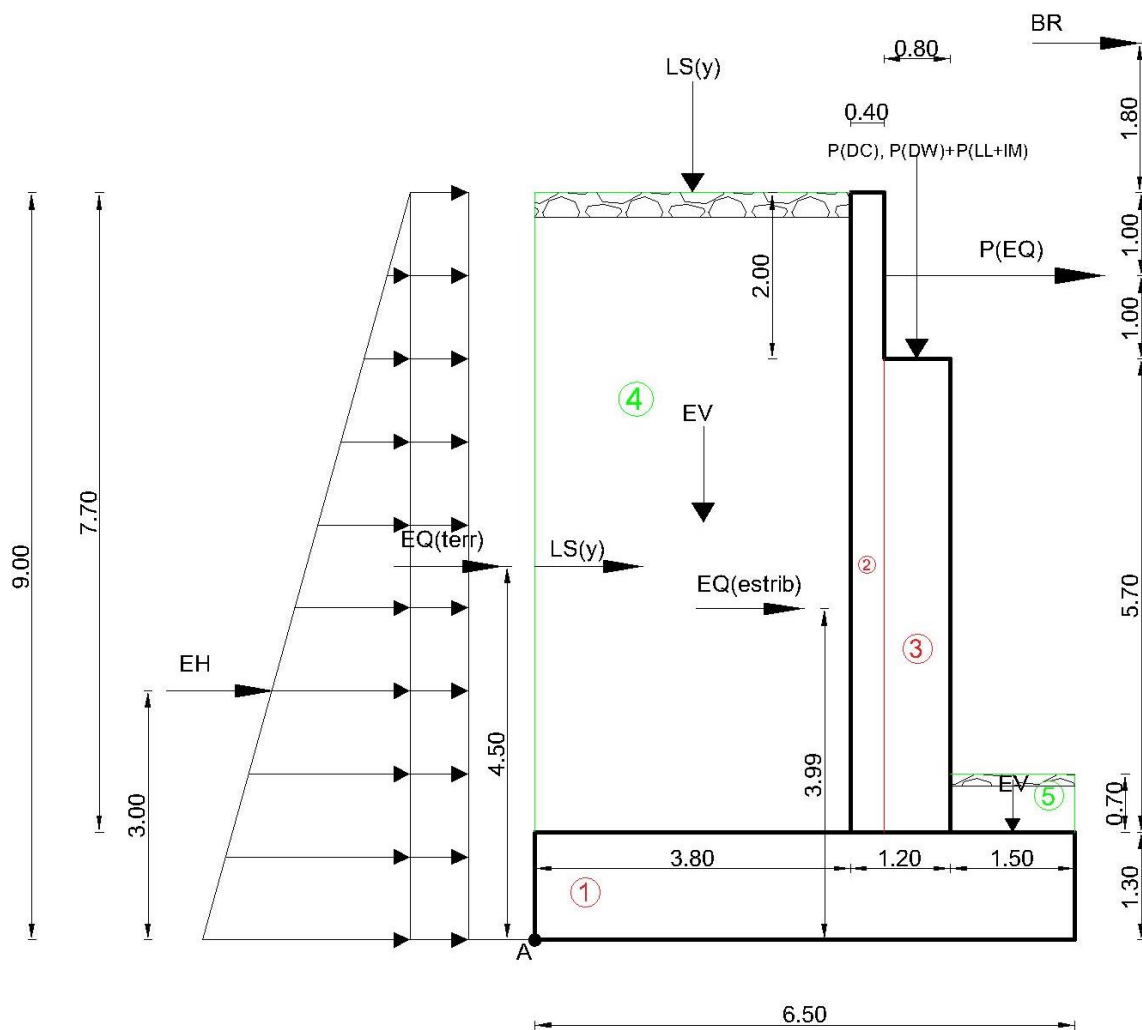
74: Cargas que actúan en el estribo (Fuente: Elaboración propia)
